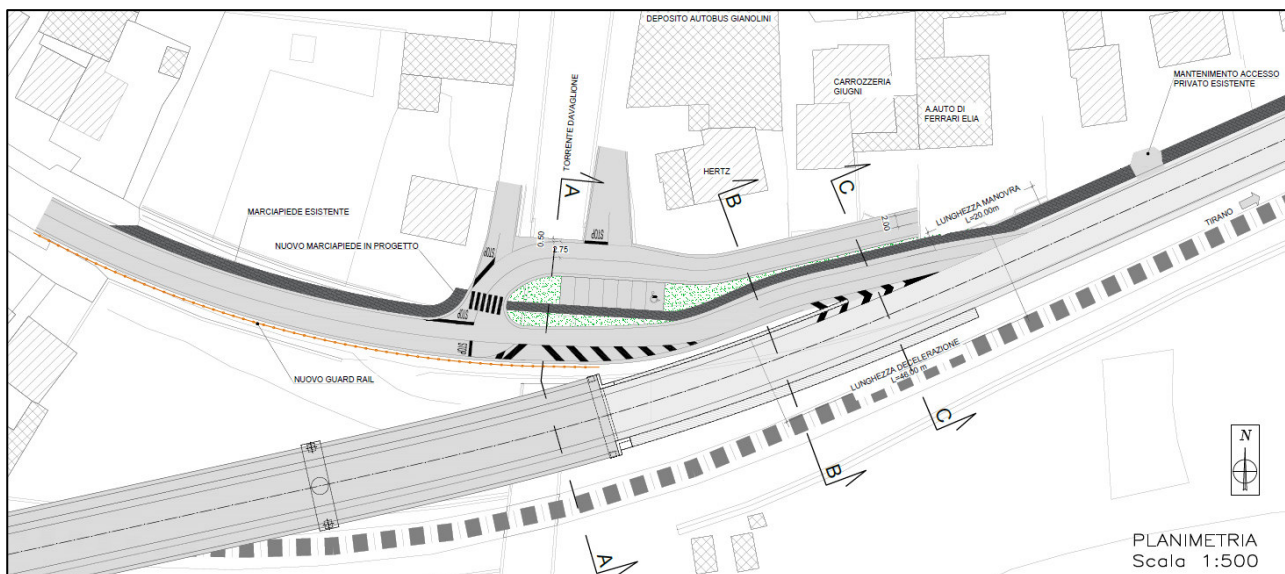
estratto planimetria di progetto uscita “Trippi”.
